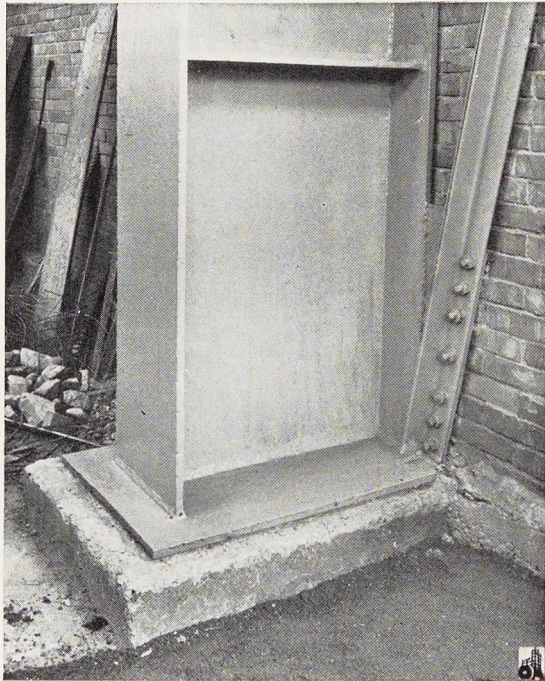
(ci-dessus). Pied de colonne et sa dalle de fondation.
